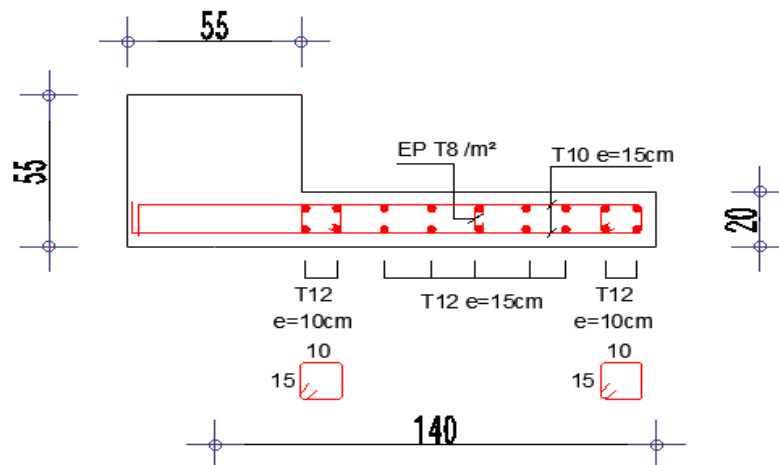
Schéma exemple de ferrailages voiles VY4/VY5 Zone I
